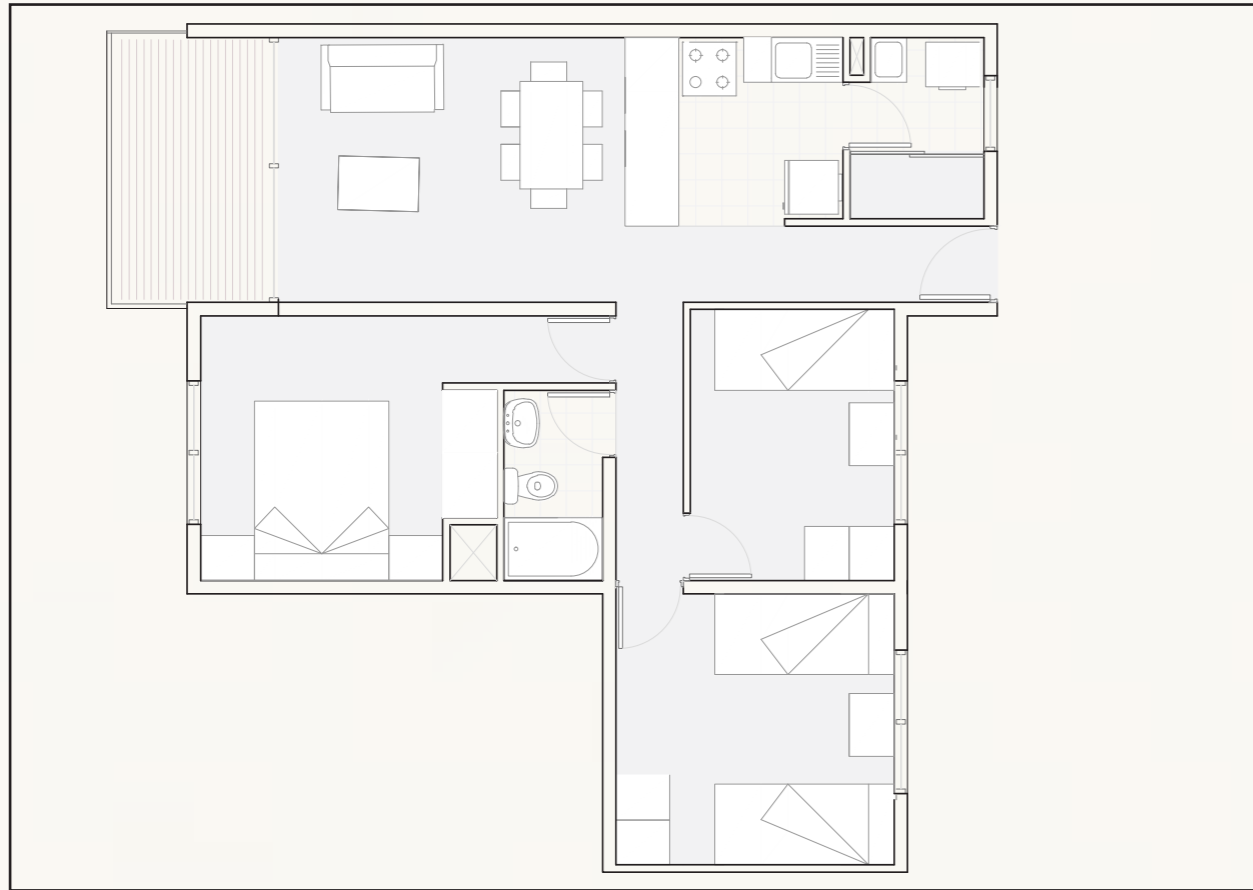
Planta tipología 3 de vivienda | Fuente: Elaboración propia
